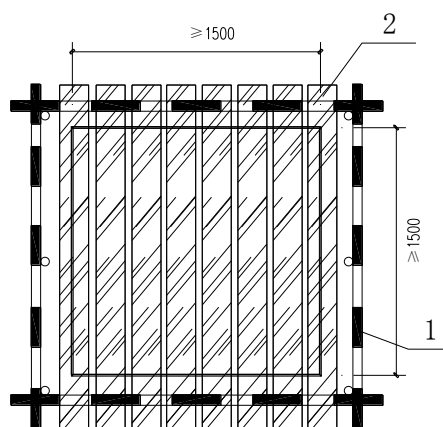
采光井安全防护平面示意图（单位：mm）
